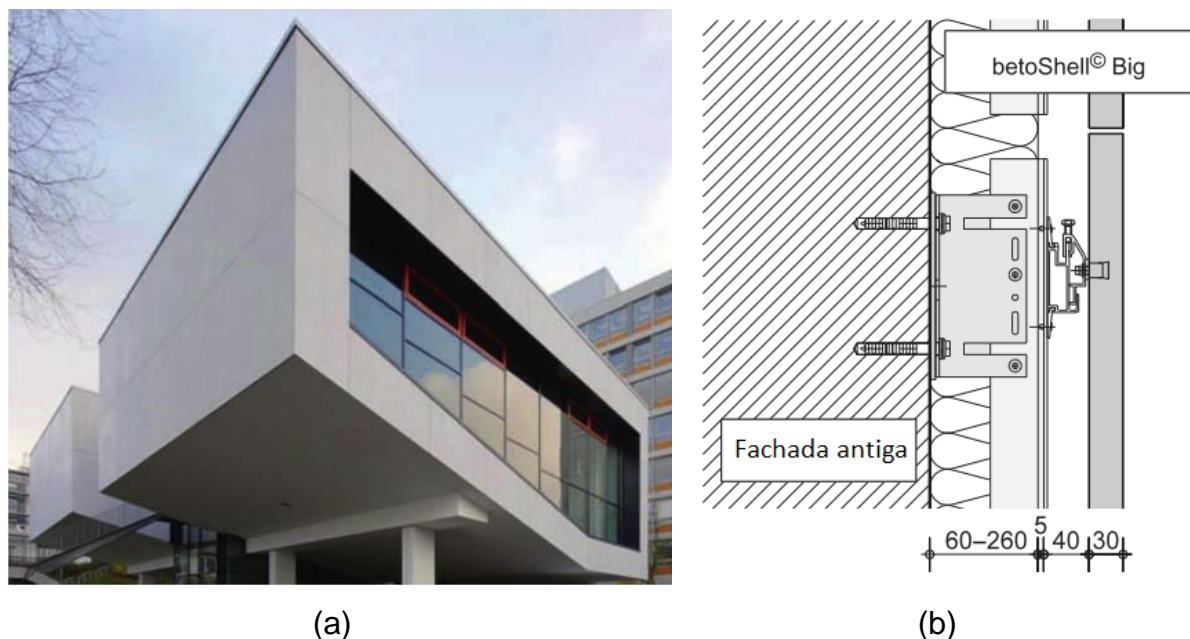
Painel sanduíche em edificação em Aachen, na Alemanha
